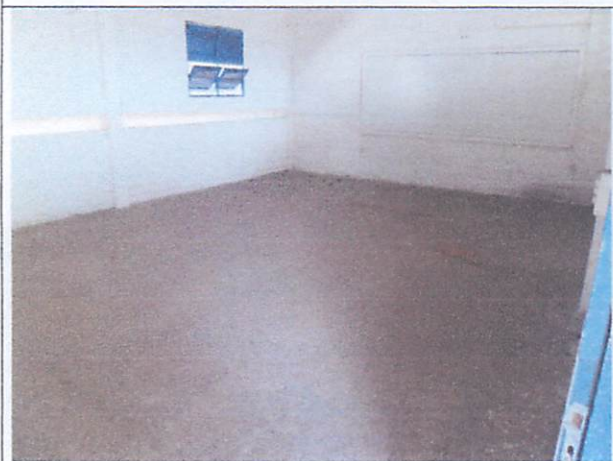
Detalhe da Edificação 02, contendo sua vista lateral
